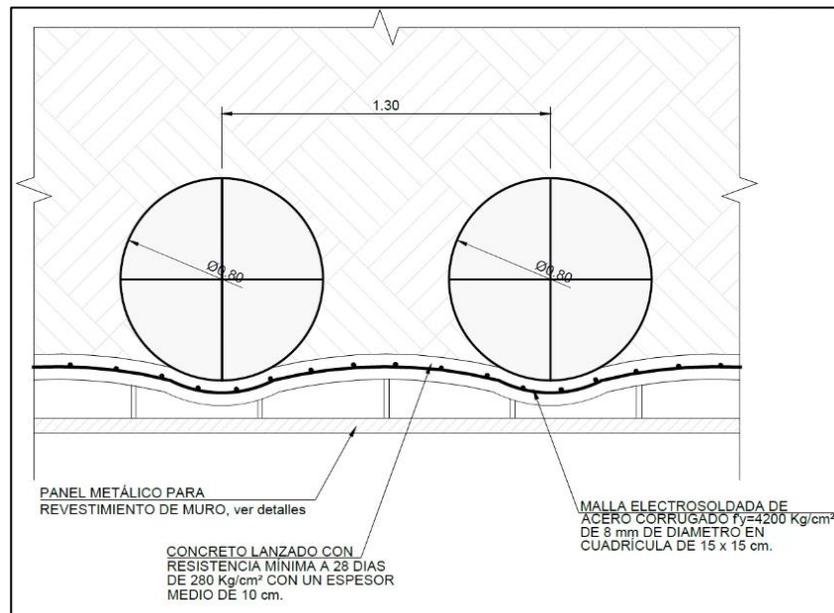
Detalle del sistema de impermeabilización para los muros pantalla de pilotes
